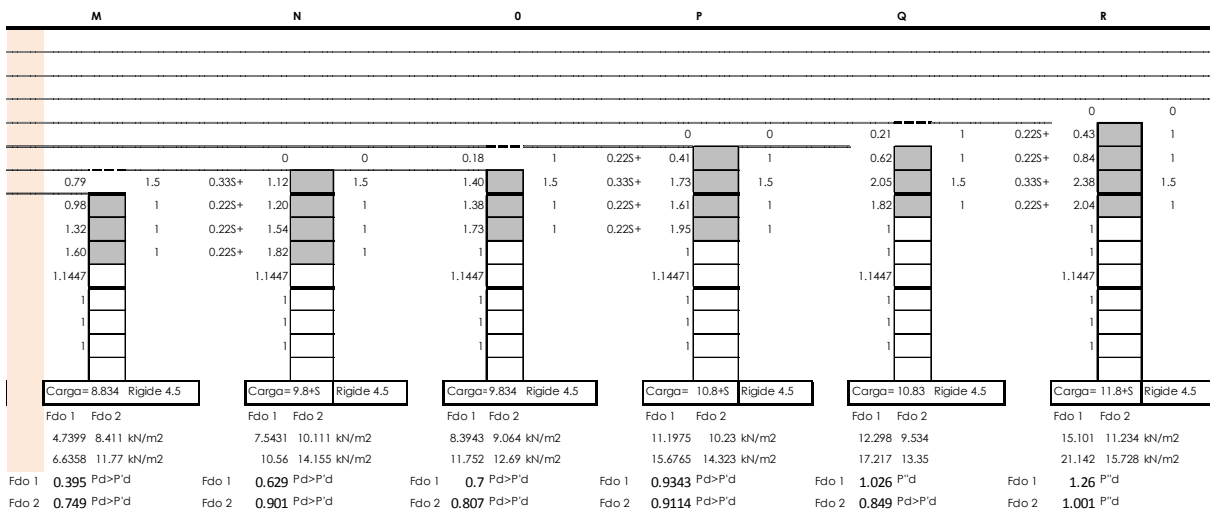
Proceso Constructivo. \$ cimbras 3 forjados de sacrificio. Losa Maciza. 3/5
